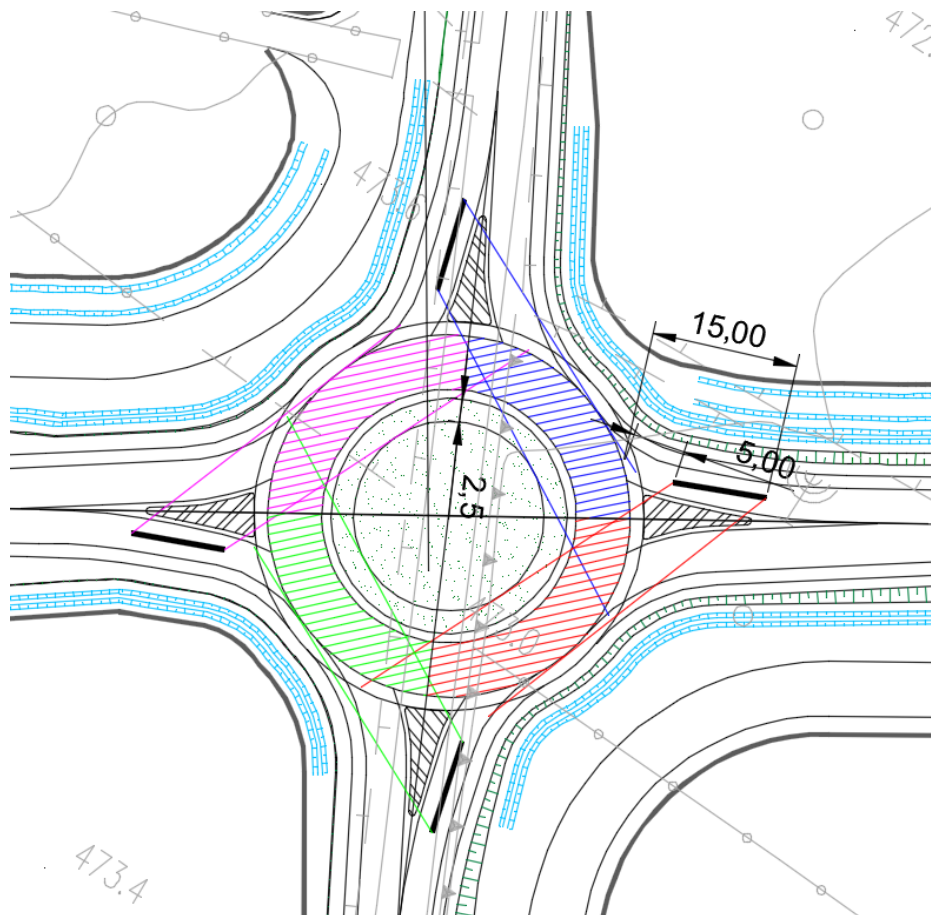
Planimetria di progetto Rotatoria 7- Km 12+709,81
